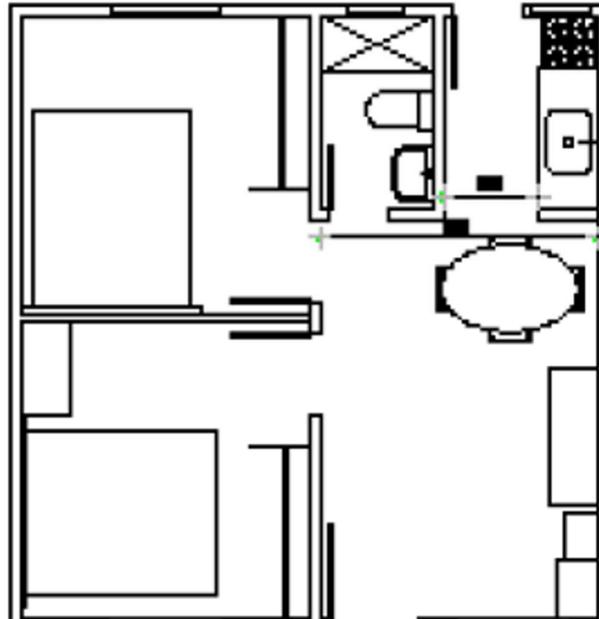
Planta Arquitectónica actual de la vivienda de 36 m<sup>2</sup>
